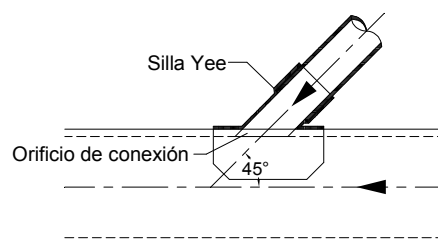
Detalle isométrico de acometidas en pavimento rígido.
